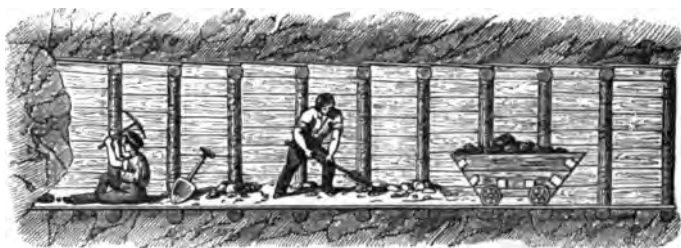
Coupe longitudinale d'une galerie en percement, avec boisage complet.
